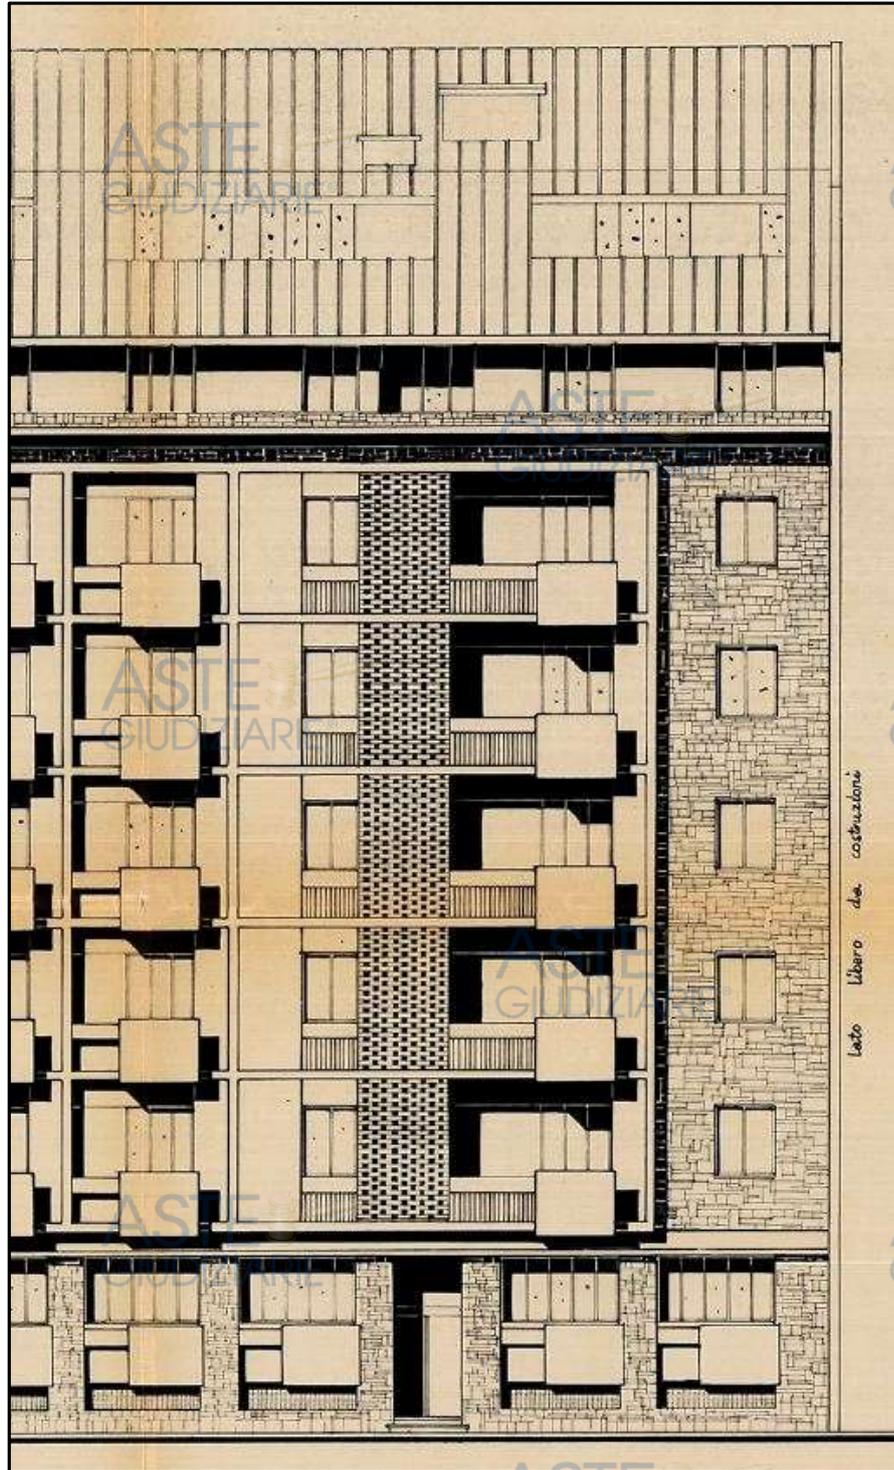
Estratto prospetto su Via Paolo Sarpi, licenza 11094 del 1958
